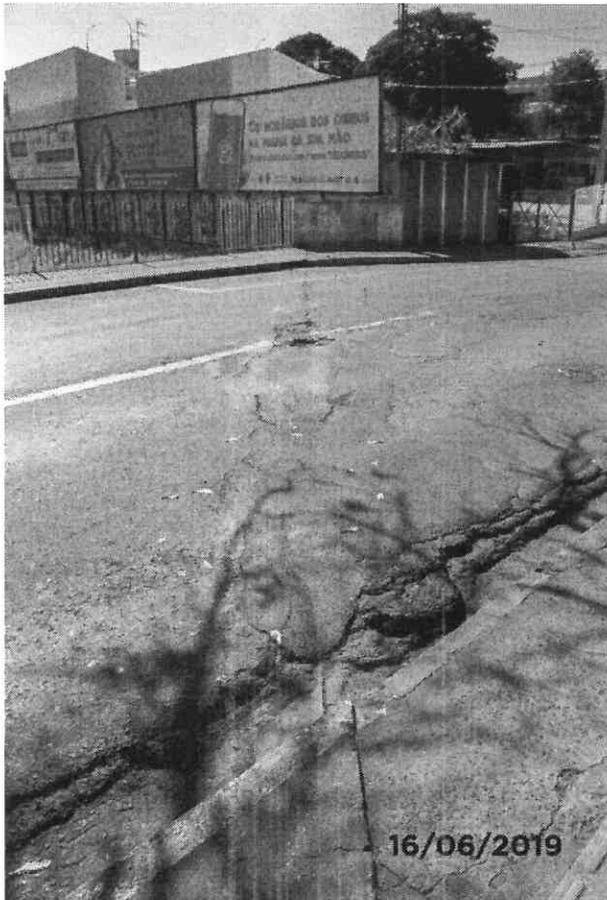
Detalhe da fissura e depressão da junta de dilatação.
